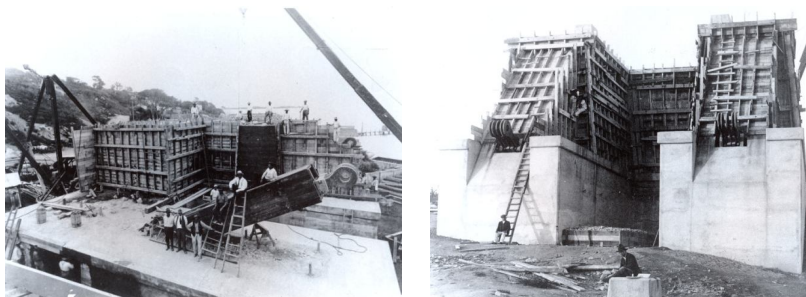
a – Escavações em rocha para a construção do maciço de ancoragem insular e b – Perspectiva do maciço insular.
